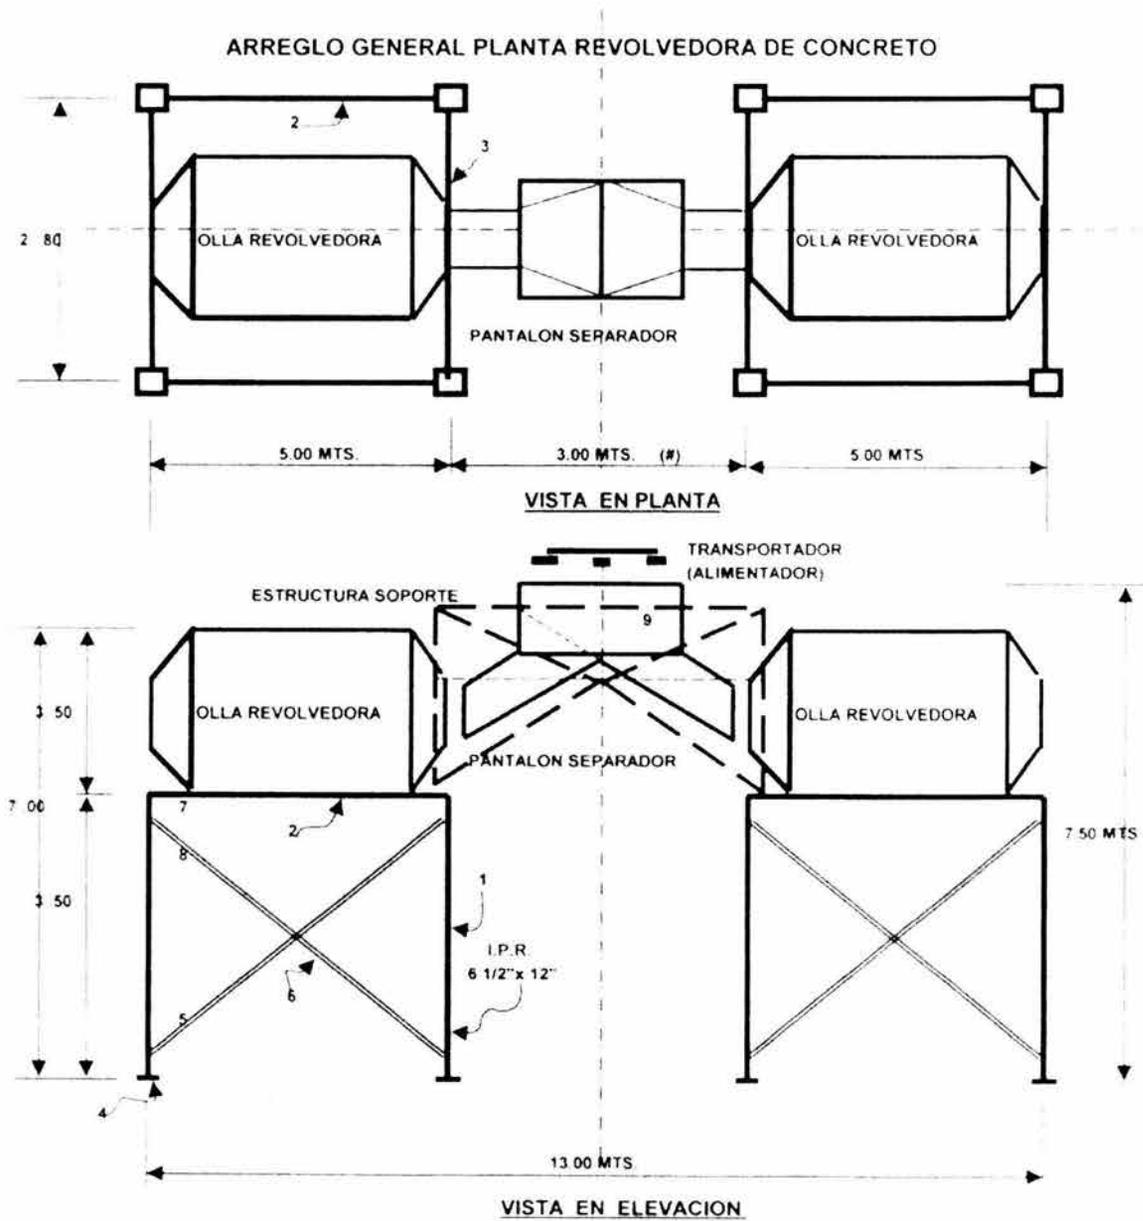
Arreglo General de la Planta Revolvedora de Concreto.
